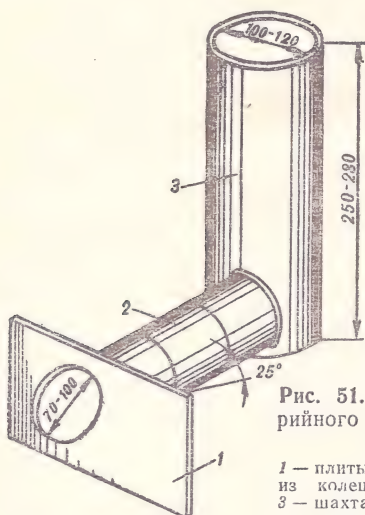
Вариант выносного аварийного выхода из железобетонных элементов:
